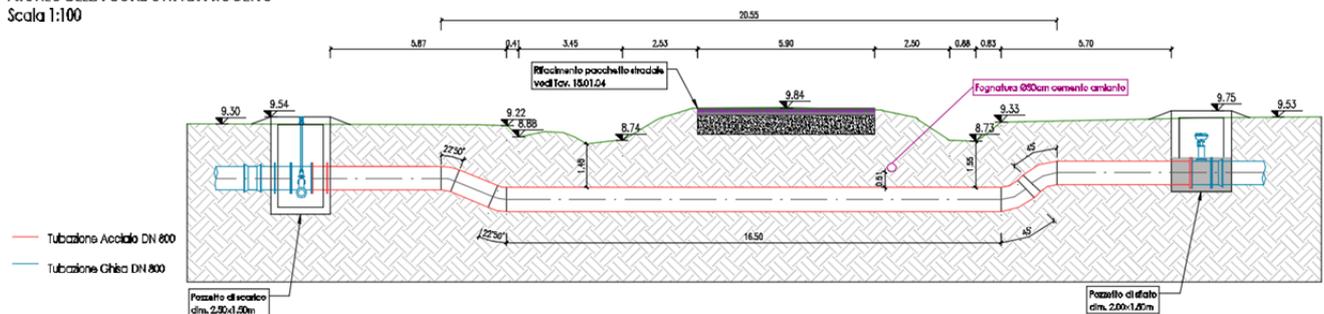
Profilo longitudinale dell'attraversamento della Strada Provinciale n. 18
